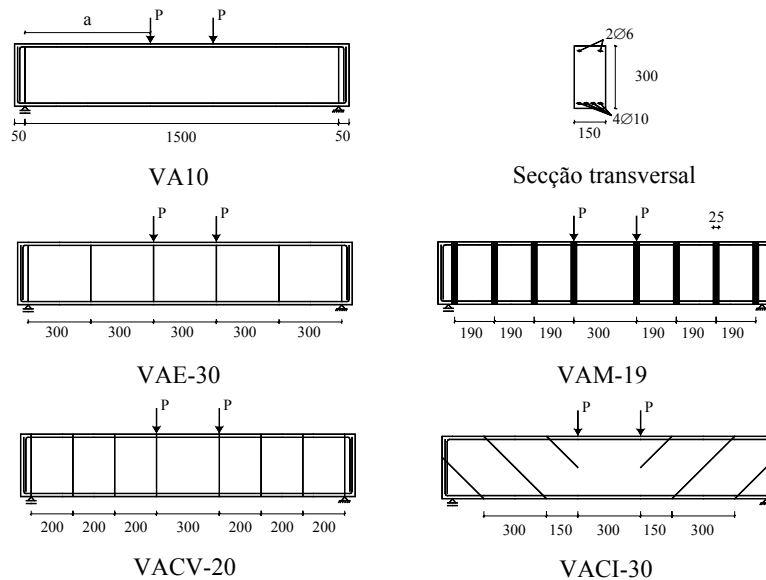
Vigas ensaiadas com 4 ϕ 10 longitudinais (dimensões em mm).
